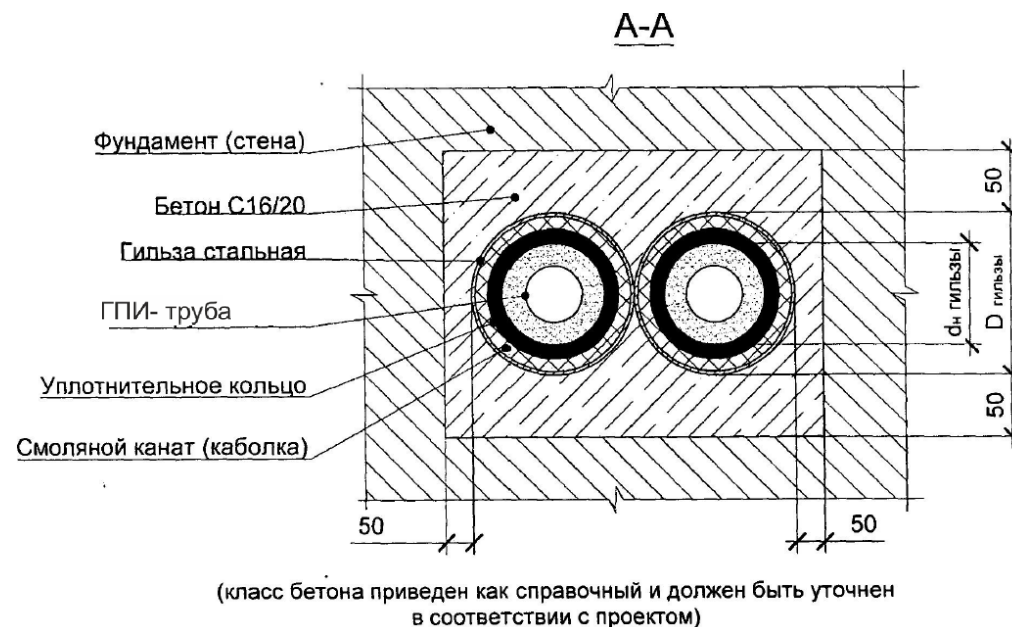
Узел прохода ГПИ-труб через строительные конструкции
